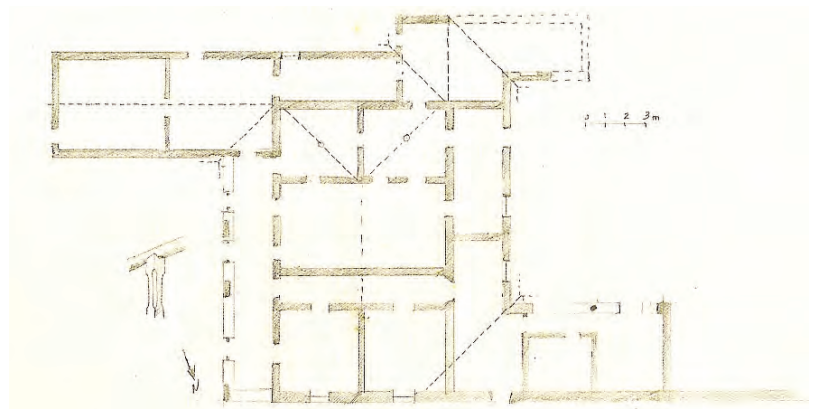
Levantamento arquitetônico da Fazenda Cana Brava: ago/1987.
